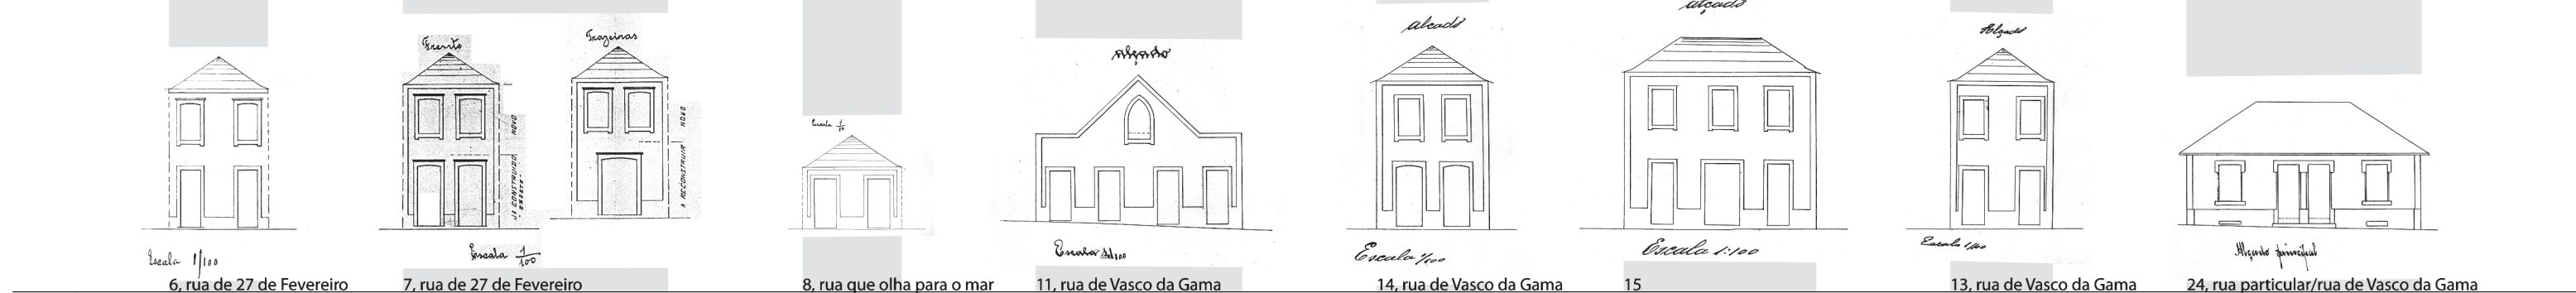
Alçados de casas de ruas travessas da Afurada, implantadas na posição de gaveto.
